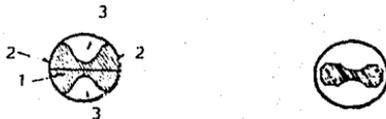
Aspesto del barreno en sección y visto por debajo.
